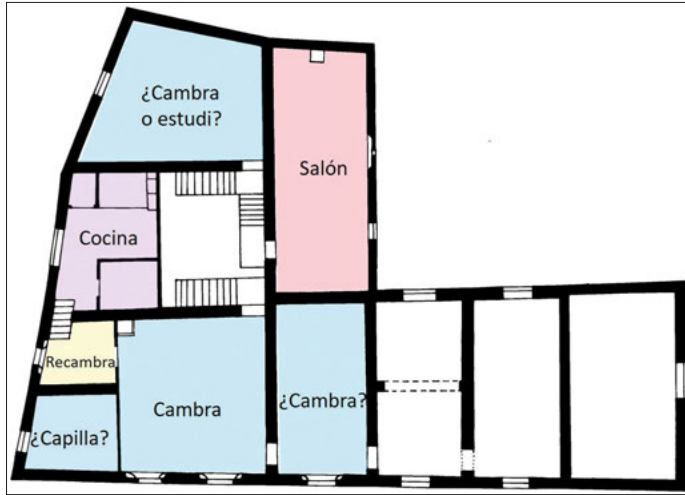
Planta de los niveles de entreplanta y piso de la alquería de Barrinto.
